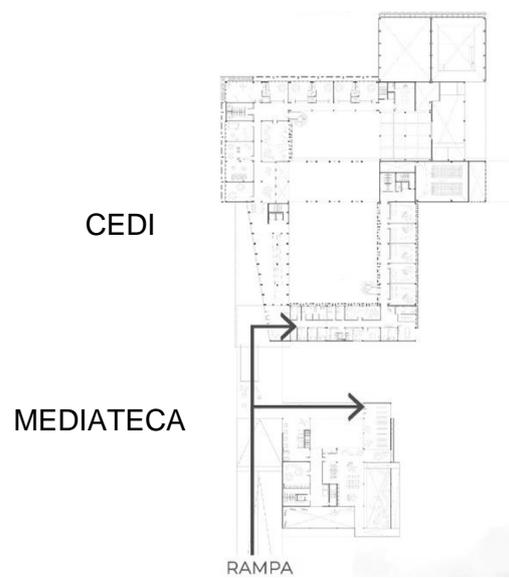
Acceso secundario por rampa urbana al bloque educativo terapéutico del CEDI. (Planta primer piso).
